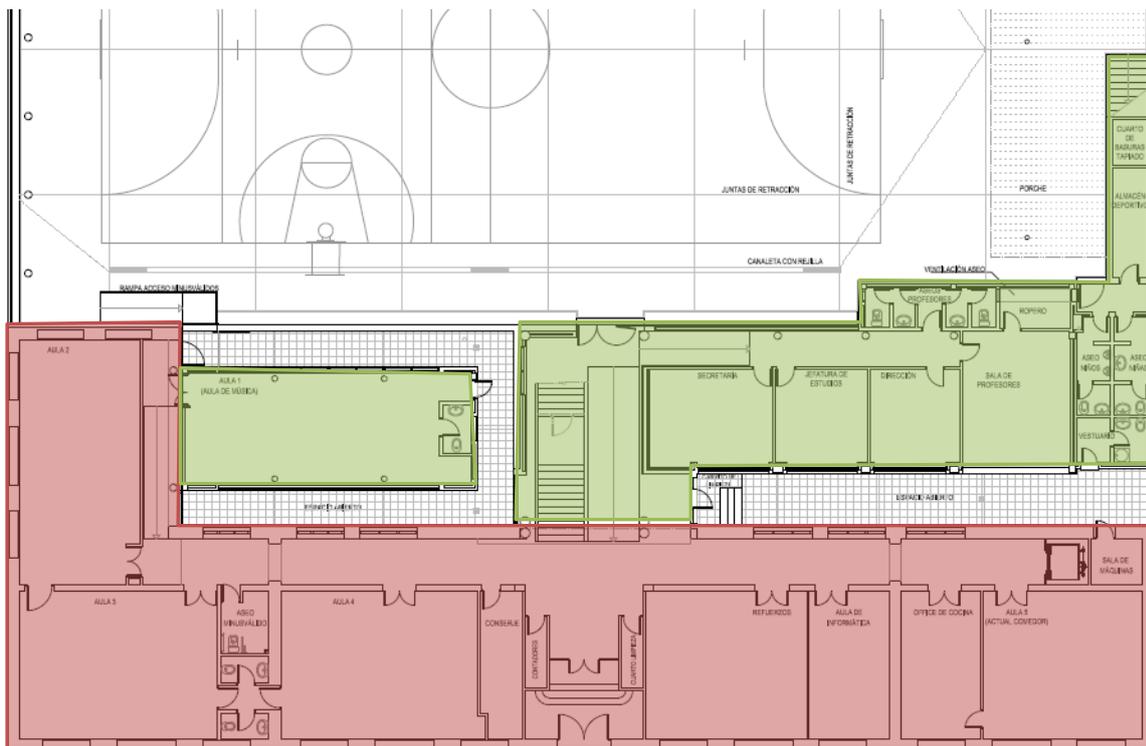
Zonificación de área reformada y área de nueva planta (planta baja)
